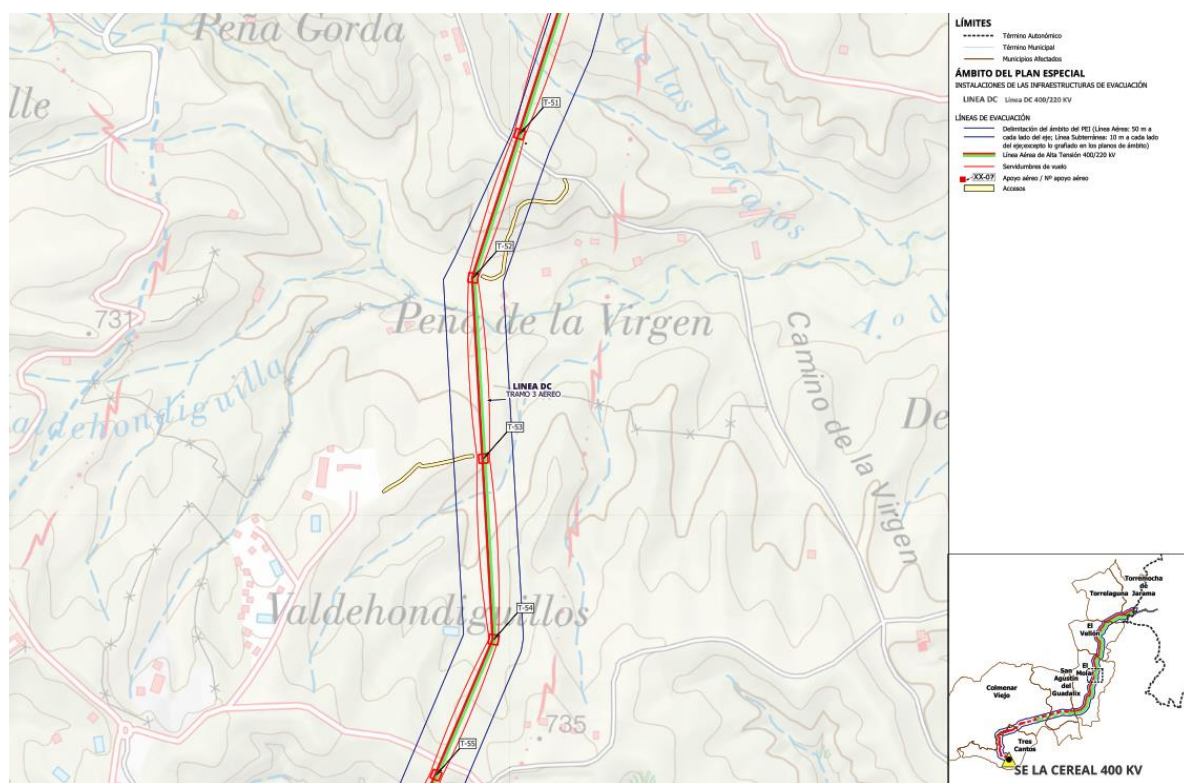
Plano de Ordenación O2.1.10. Planta por tramos LASAT 400/220 Kv – Línea DC
